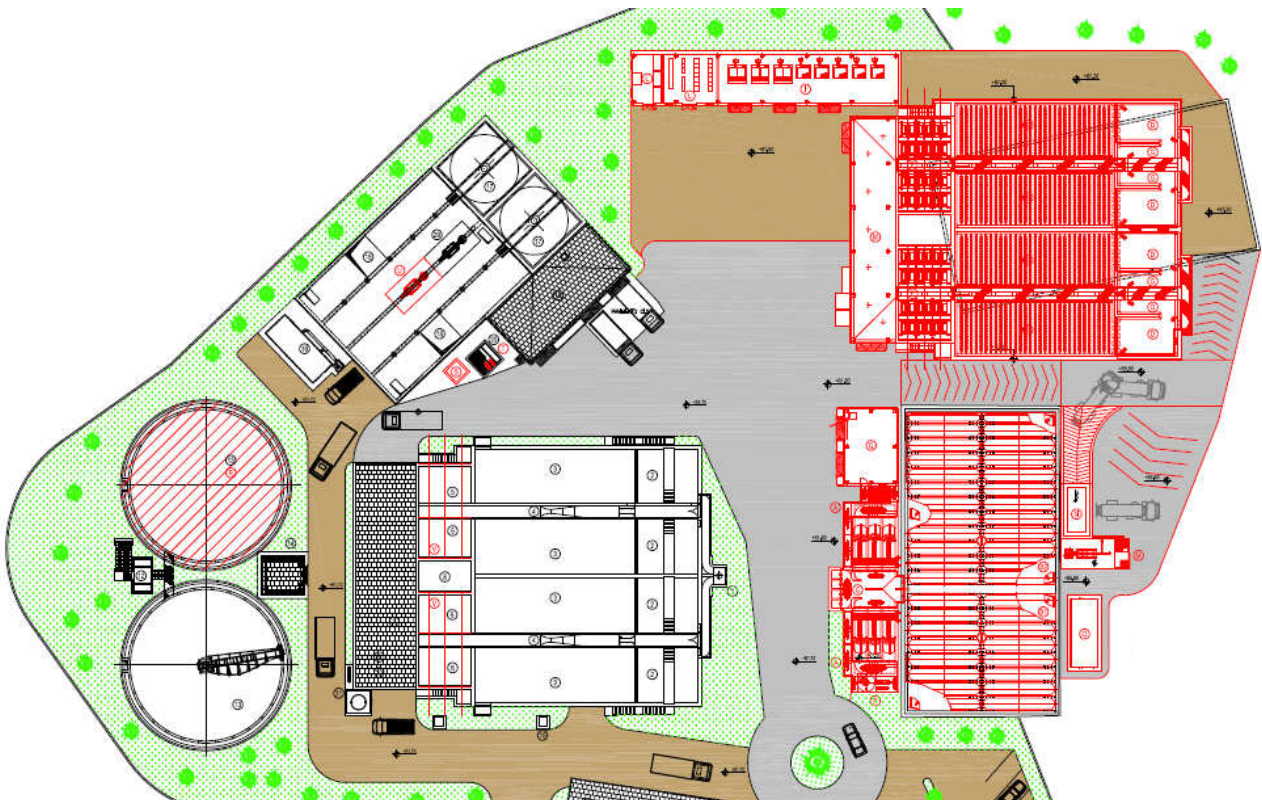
Planimetria di Progetto (in rosso le nuove opere)
